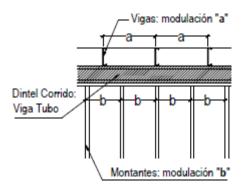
Estructura de entrepiso no alineada. Fuente: (ConsulSteel, 2014).
